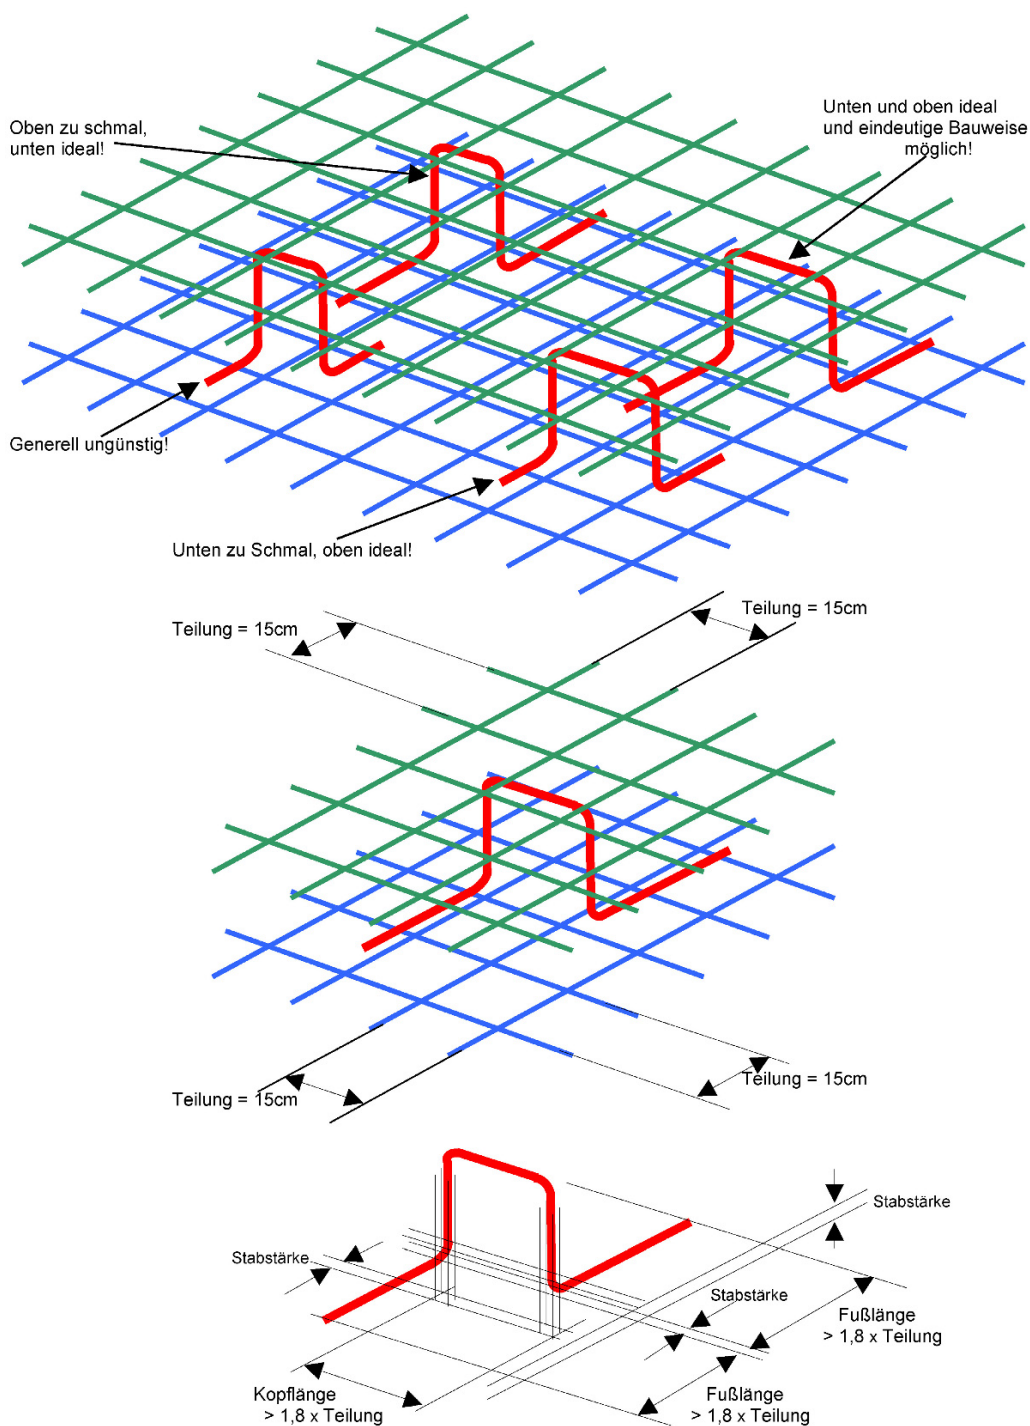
Maßkettenvergleich eines Abstandhalters (Biegeform 90) beim Plattengeflechtaufbau.
